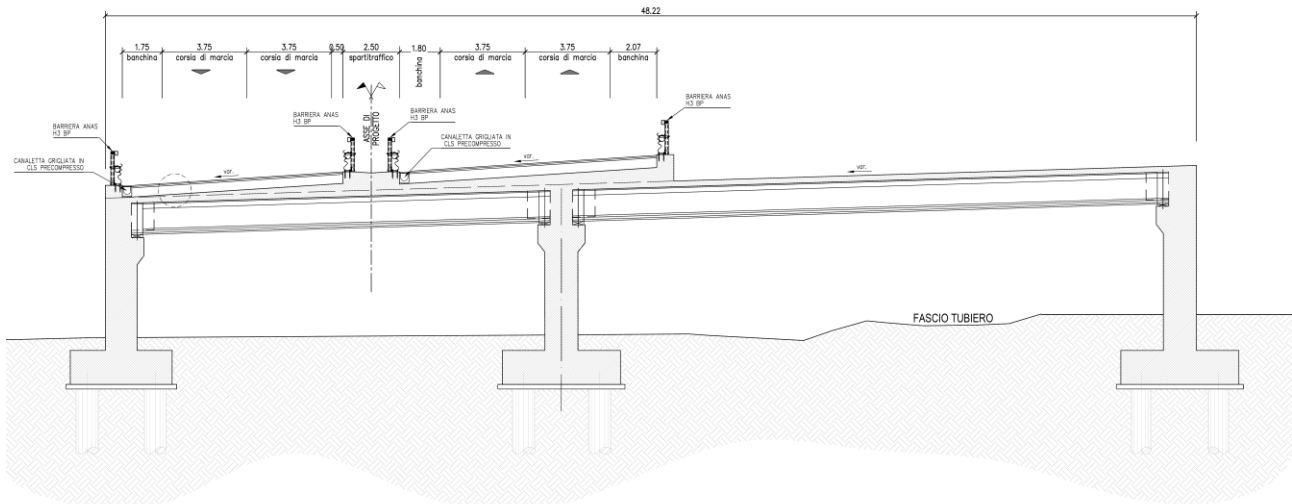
Sezione tipo dell'asse principale su opera di attraversamento
